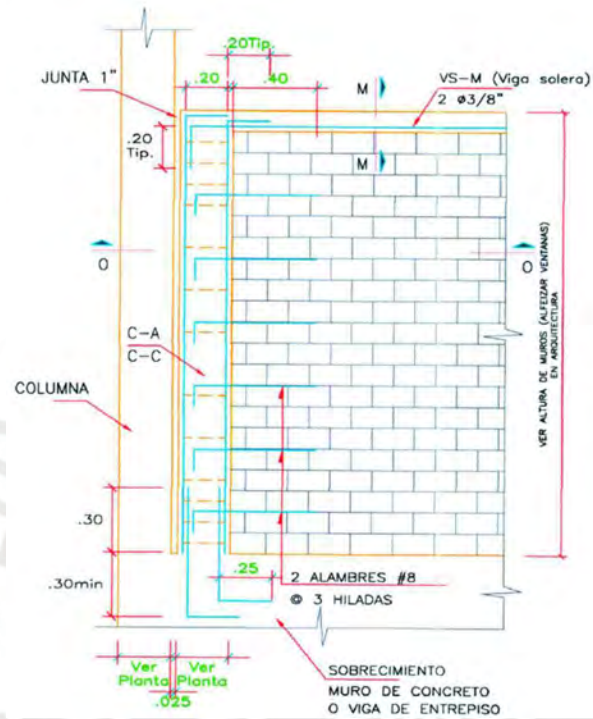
Detalle de confinamiento en muros de albañilería (Autocad)
